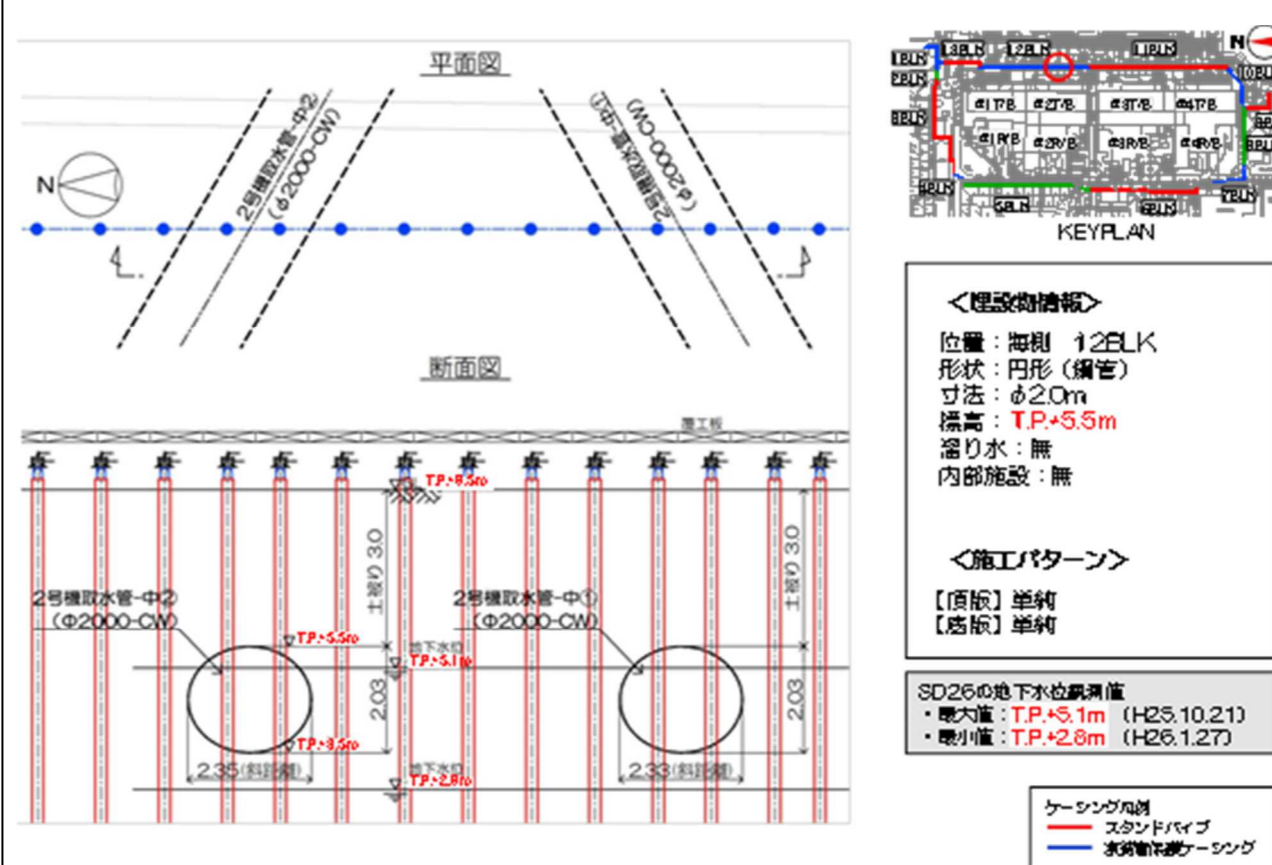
【12-2】2号機取水管-中①② 施工方法 (貫通施工)
